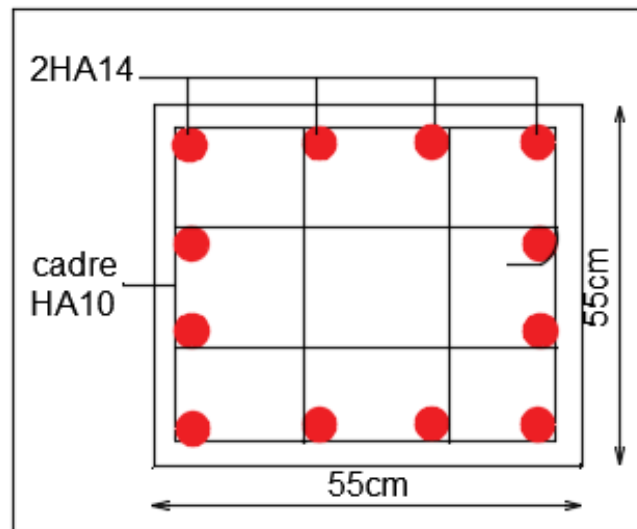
Schéma de ferrailage des poteaux 3eme et 4eme étage
